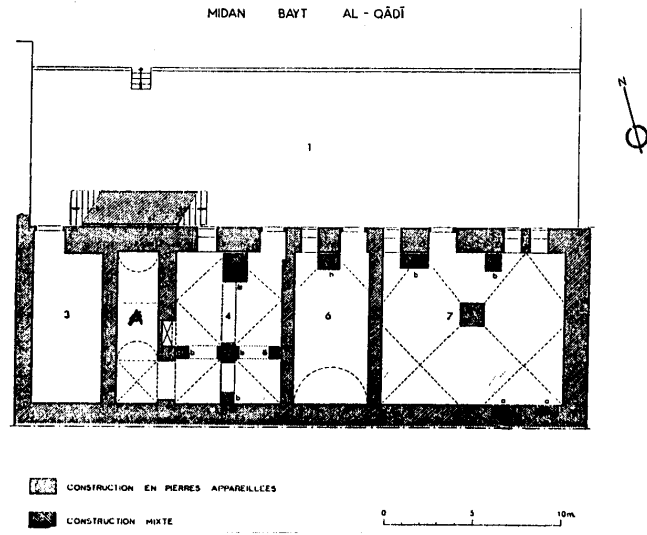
مسقط أفقي لمقعد قايتباي الواقع في الدار الأول للضلع الجنوبي الغربي من
